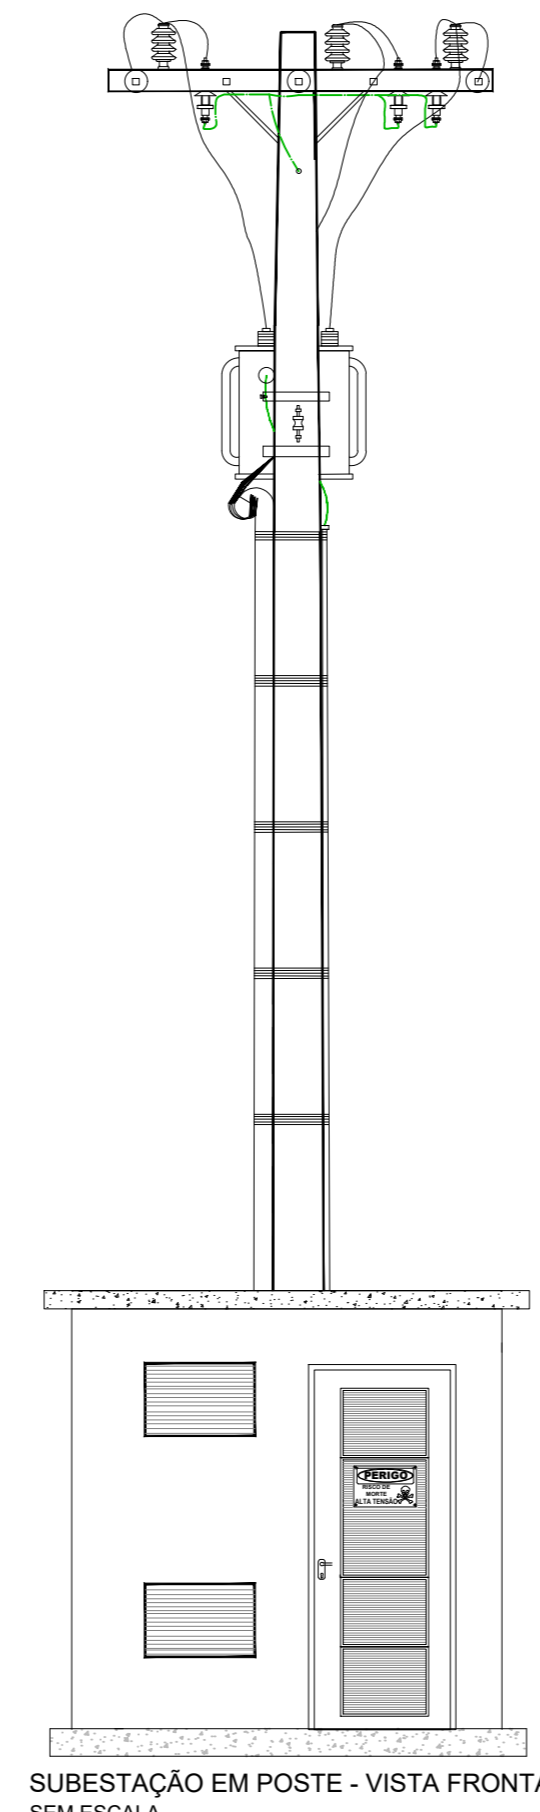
SUBESTAÇÃO EM POSTE - VISTA FRONTAL SEM ESCALA
